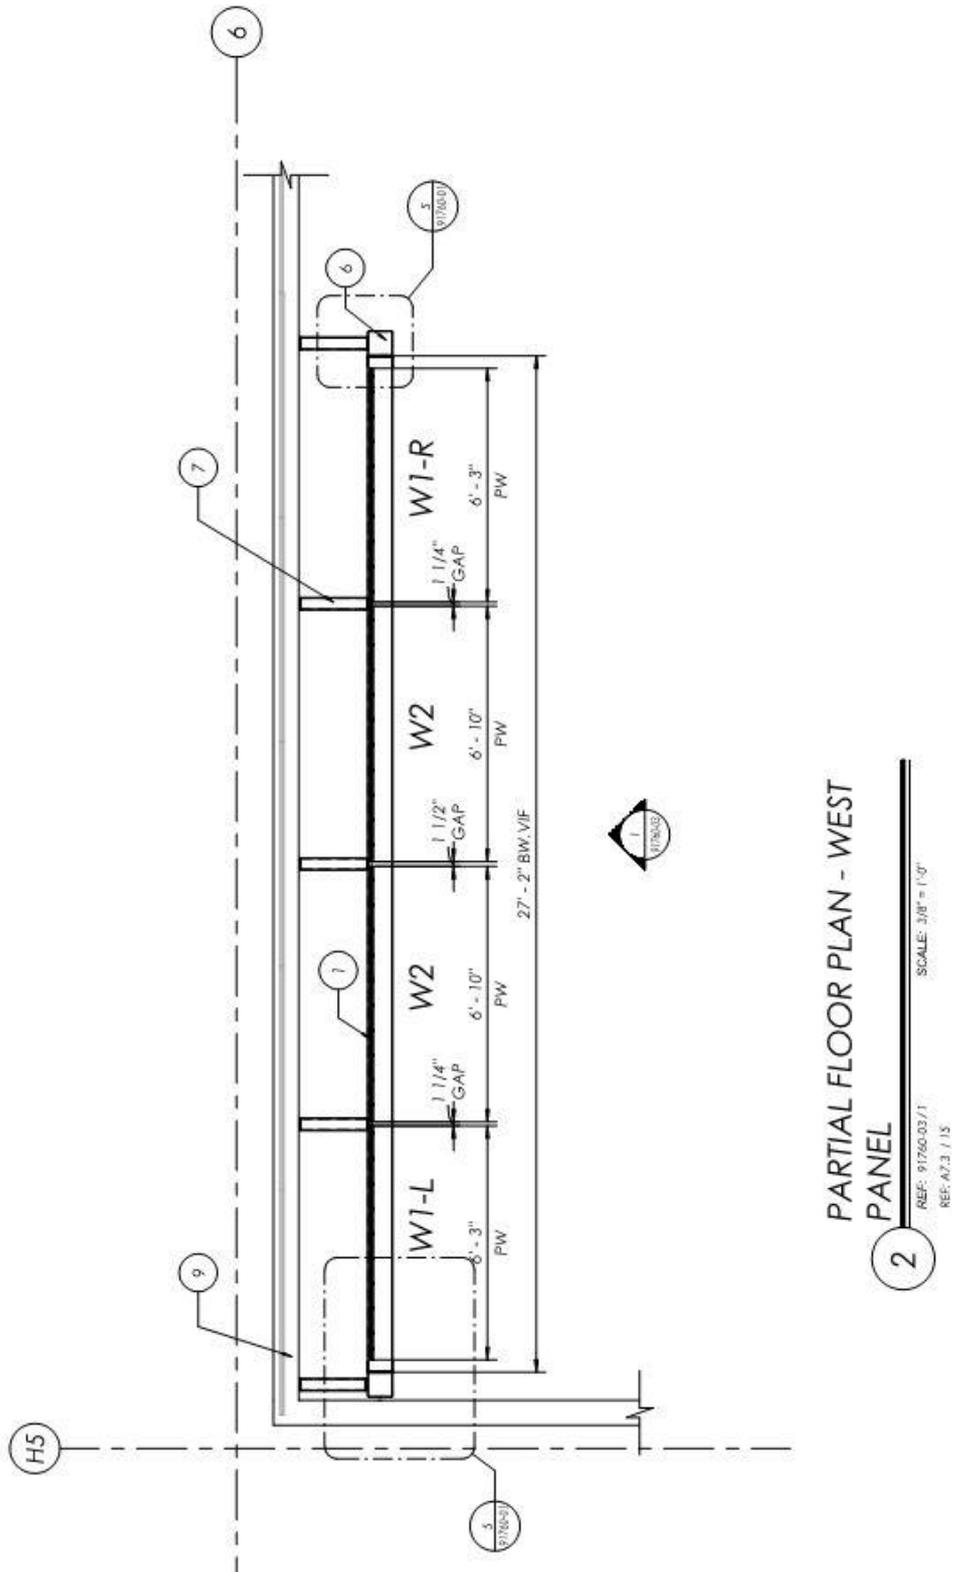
Planta de instalación de los paneles de la cara Oeste del edificio
